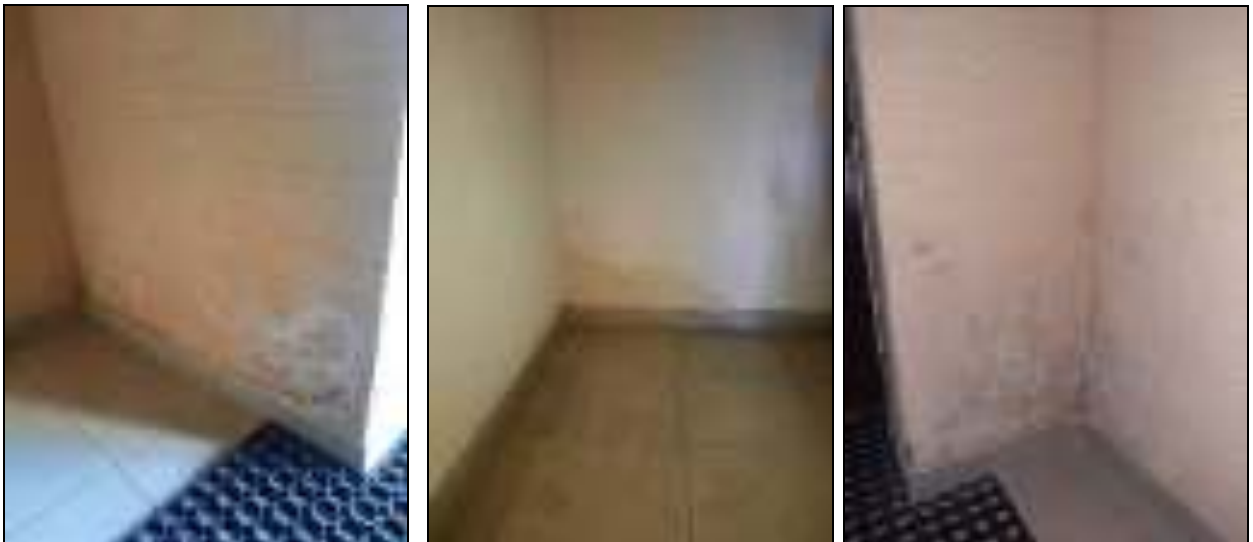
, Фото 45, Фото 46 - Намокание стен на лестничной площадке корпуса №1.
